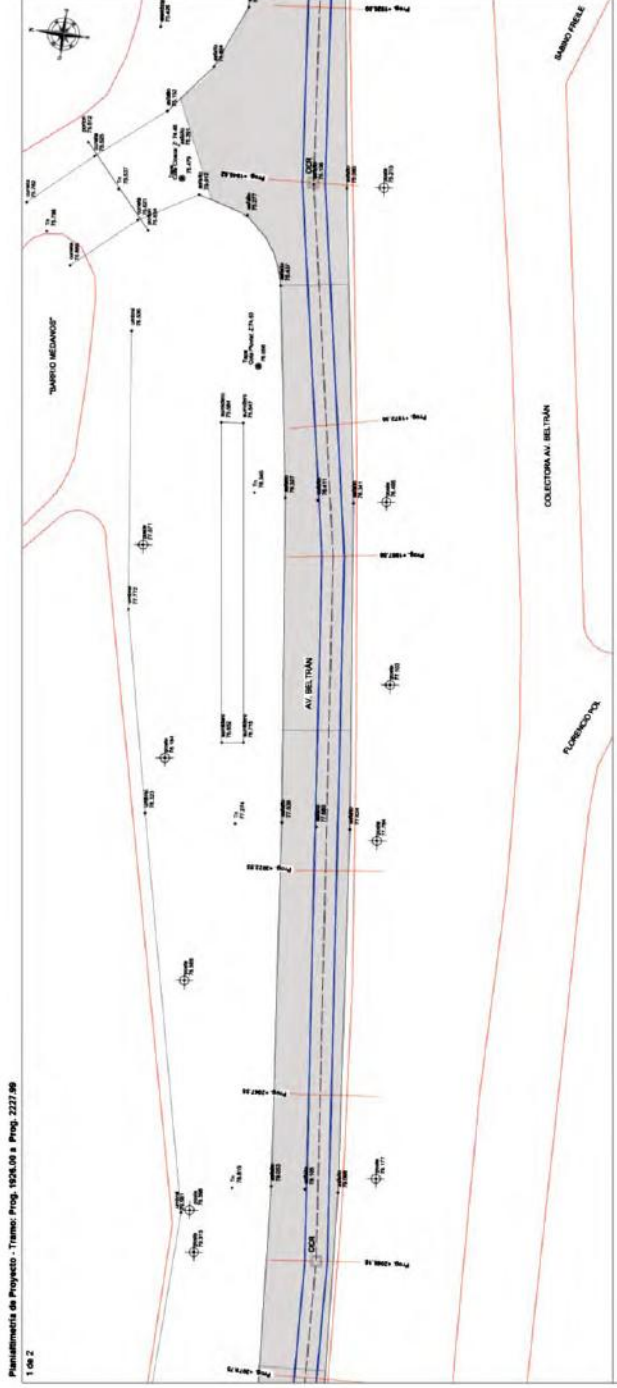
Planimetría de proyecto Tramo Progresiva 1926.00 m. a 2227.99 m.
